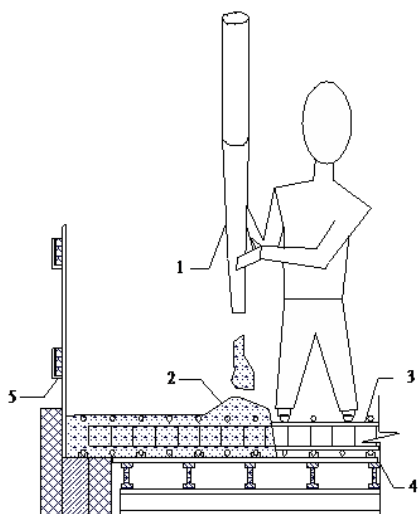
Укладка бетона: 1 –наконечник стрелы автобетононасоса; 2 – укладываемый бетон; 3 арматурная сетка; 4 конструкция опалубки перекрытия; 5инвентарное ограждение
